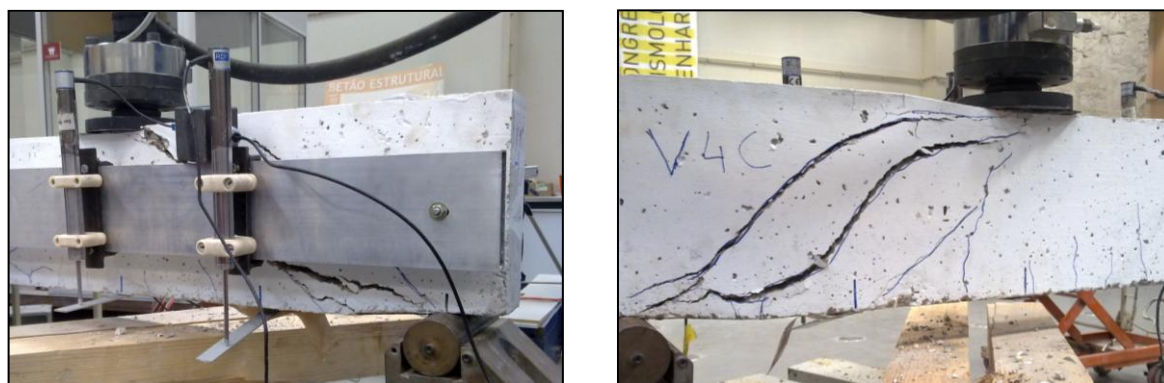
Fissuras de esforço transversal nas faces laterais da viga V4
